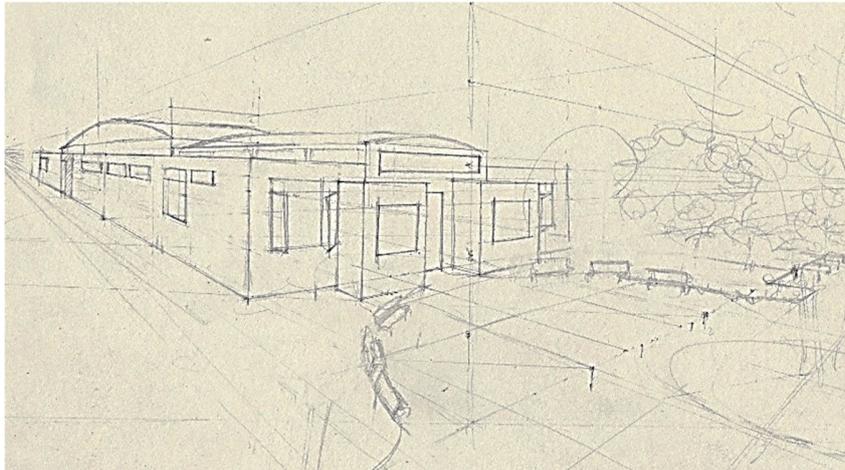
Boceto de la perspectiva del edificio vista Sur-Oeste. Elaboración propia.
